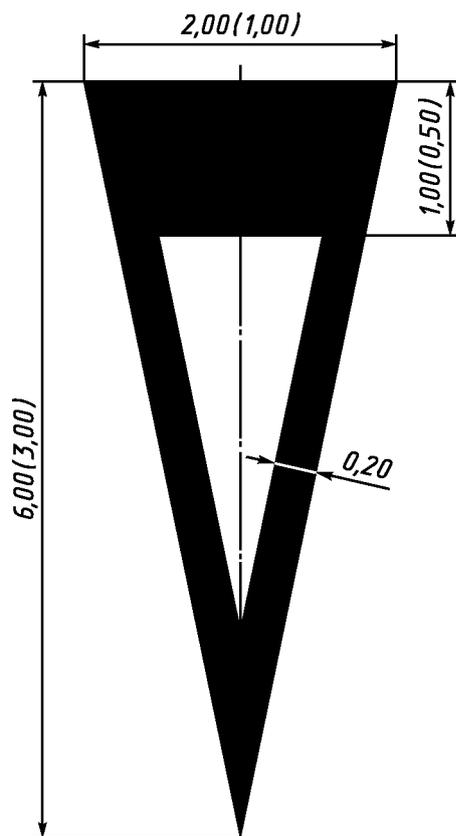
Форма, расположение и размеры стрел разметки типа 1.19
